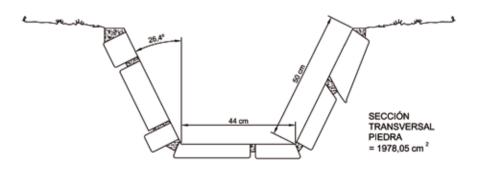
Perfil transversal revestimiento de piedra junta tomada (Q=250 lt/seg).
